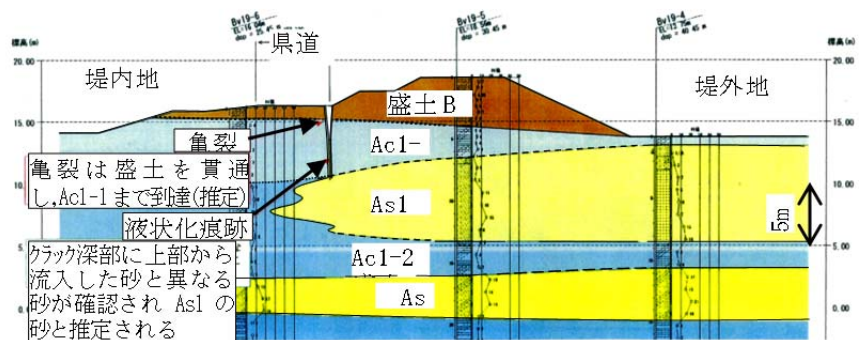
地盤断面図(F断面。土層記号は図-4参照)³⁾
